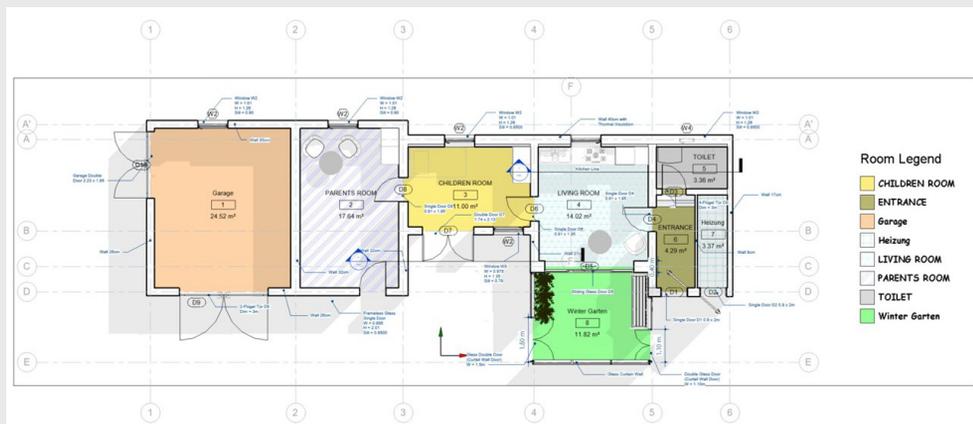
Ableitung des beschrifteten Grundrisses aus dem BIM-Modell
